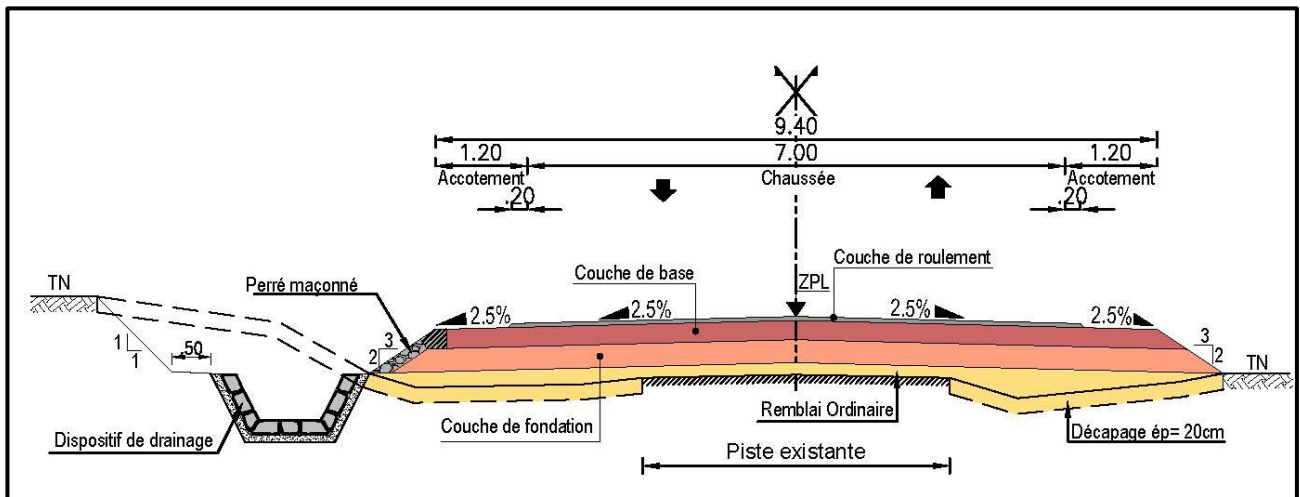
PROFIL EN TRAVERS TYPE 1
